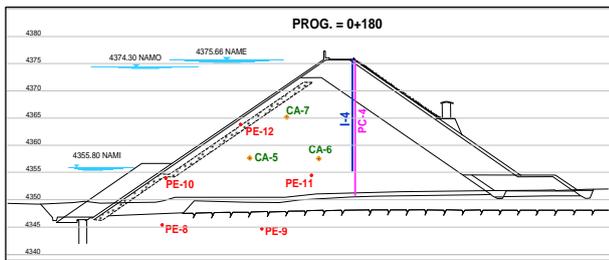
Ubicación de piezómetros, celdas de asentamiento e inclinómetro en la Sección 2-2 de la presa Pillones
